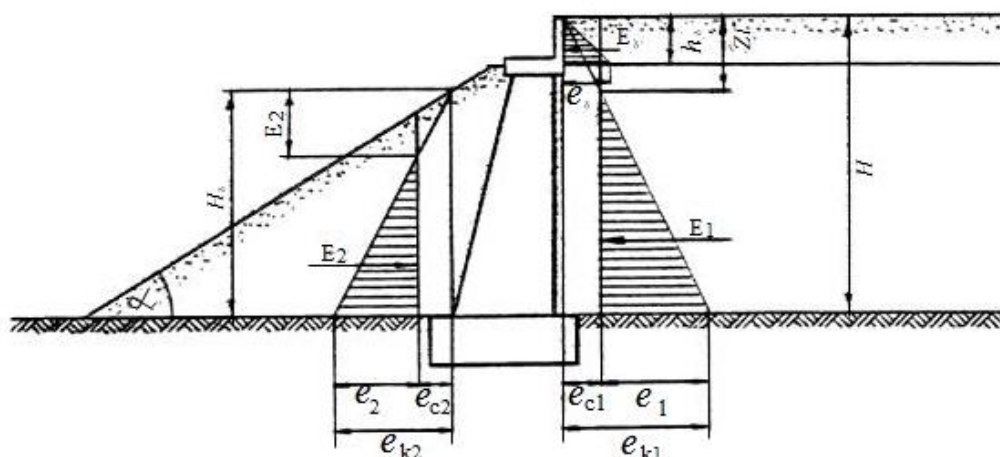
Схема к расчету давления грунта на устои с фундаментами козлового типа, мелкого заложения, свайные и глубокого заложения
